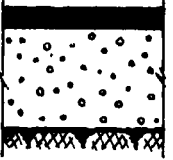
Проезд с покрытием из цементно-бетонных плит
